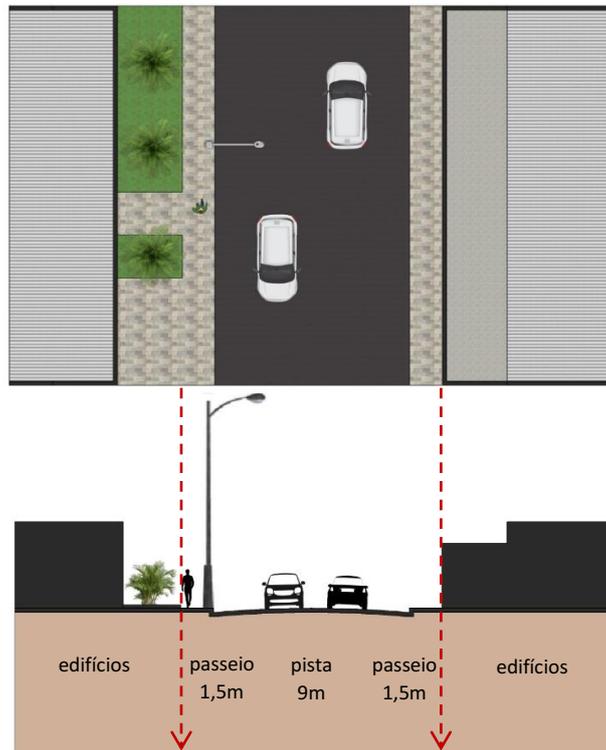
Planta e perfil viário AA da R. Rio Grande.
